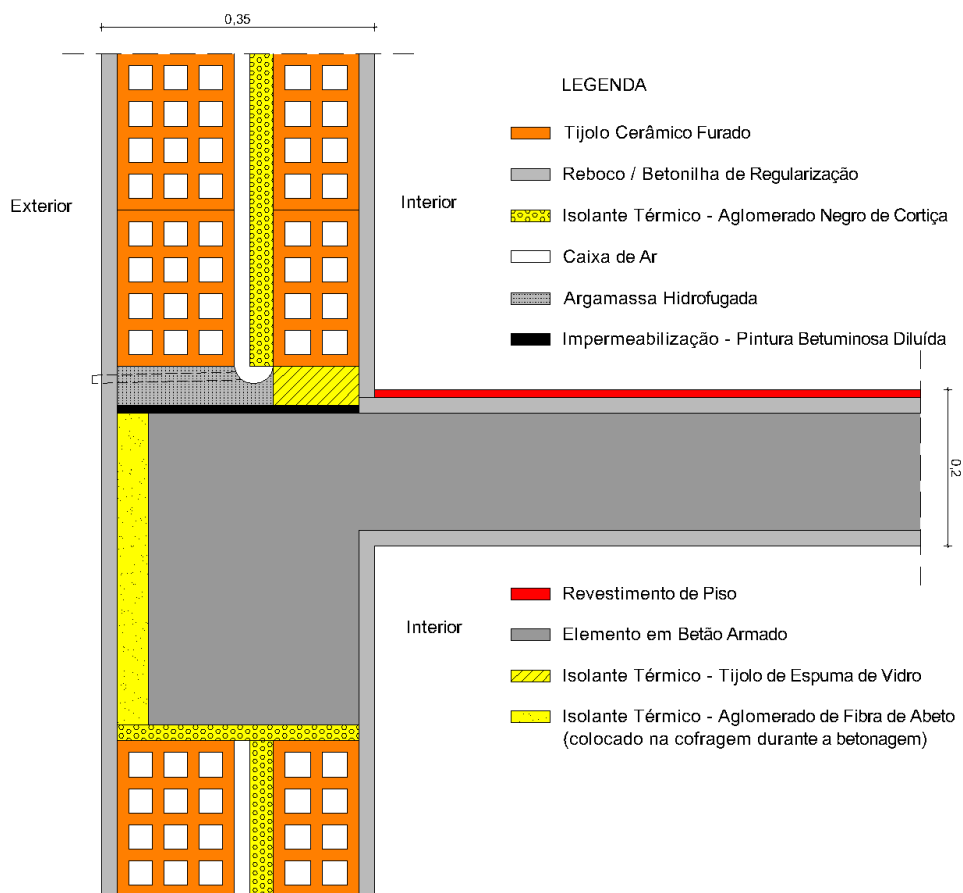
Ligação da fachada com pavimento intermédio, adaptado de [10]
